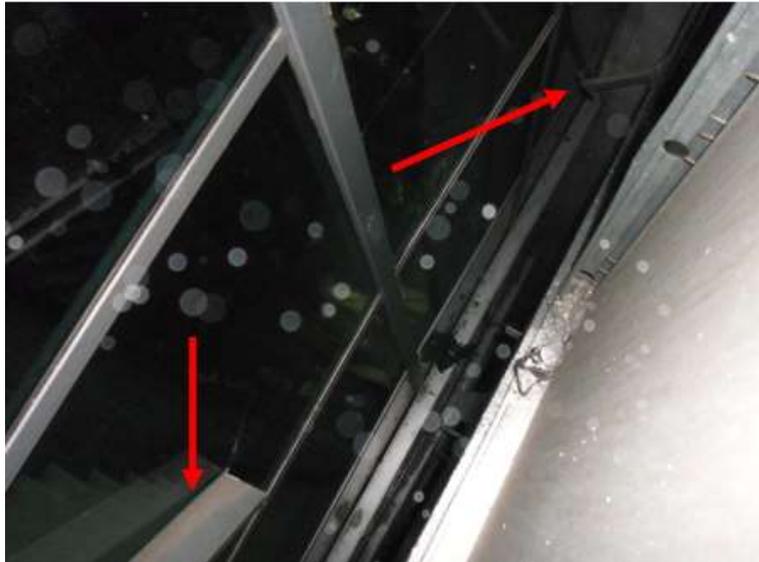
Pontos de ancoragem da estrutura prejudicados.
